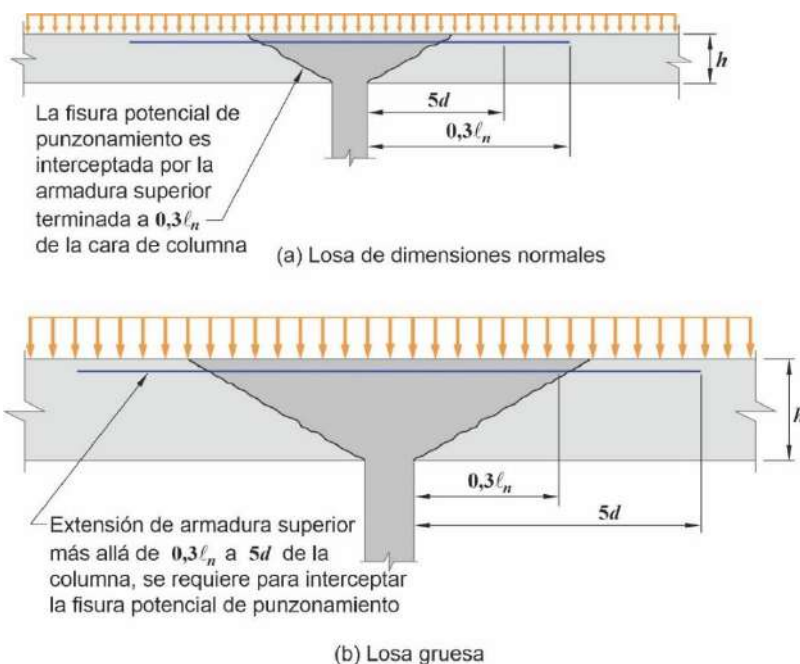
Fisuras de corte por punzonamiento en losas normales y gruesas
